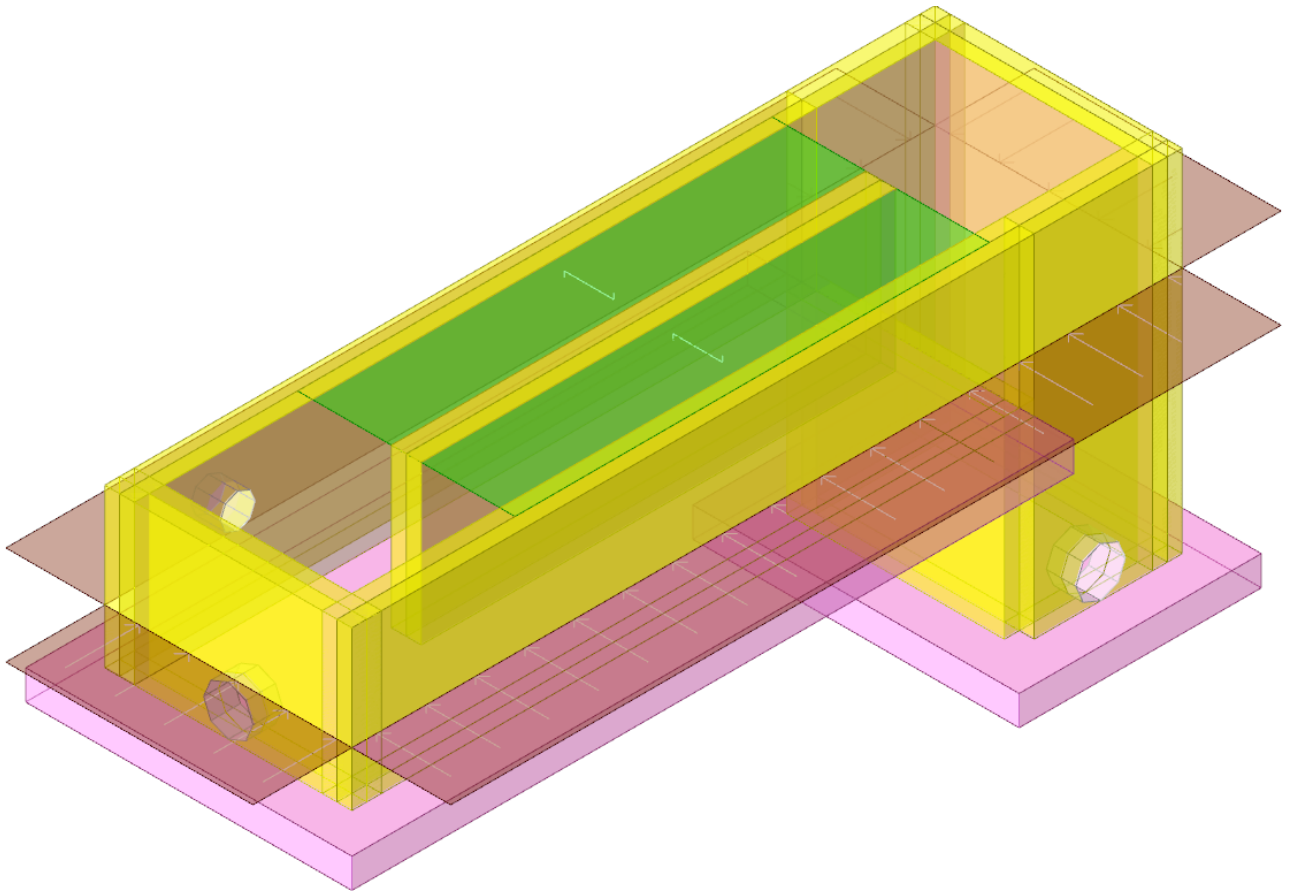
Modello tridimensionale della struttura, vista 1
